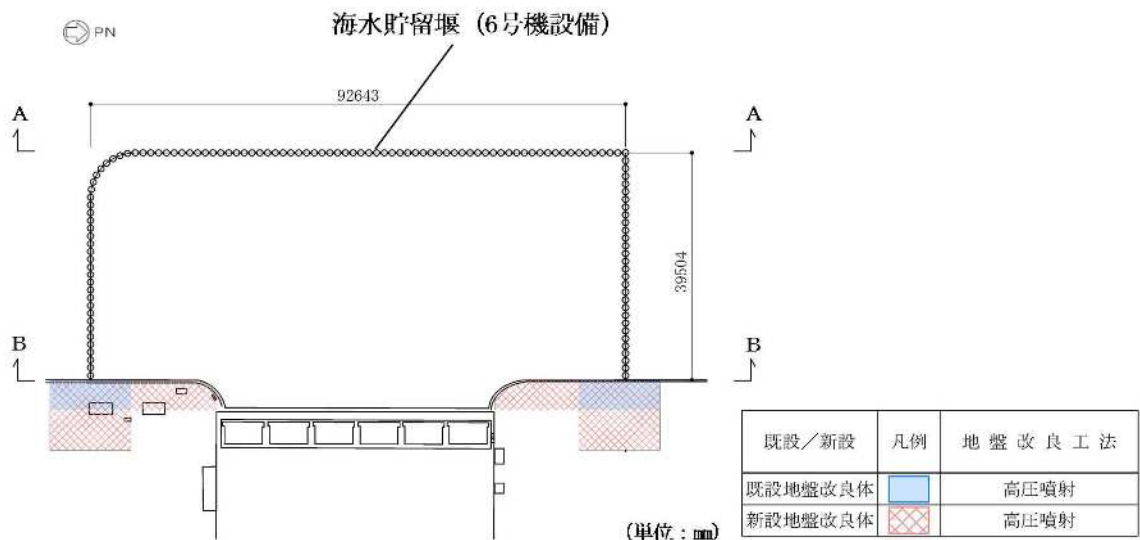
海水貯留堰（6号機設備）の平面図
